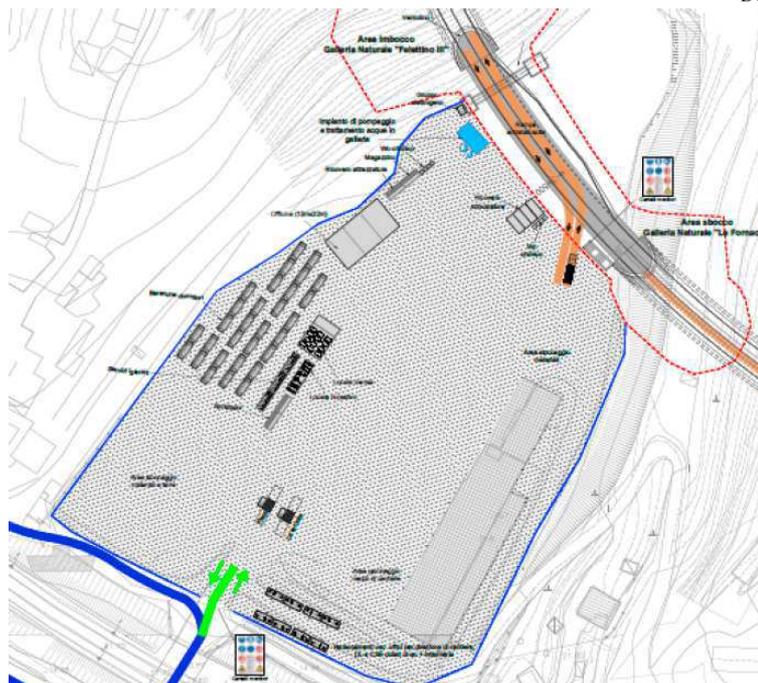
Planimetria del Cantiere Base Le Fornaci
